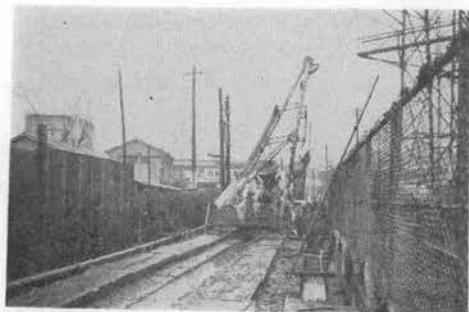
鶴見下末古幹線下水道築造工事の機械配置状況
